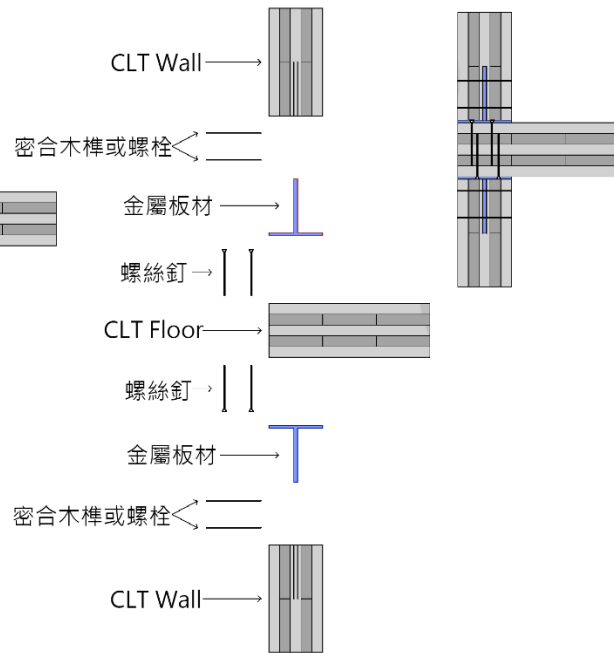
(e) Wall to Floor(Platform System)主要接合形式
